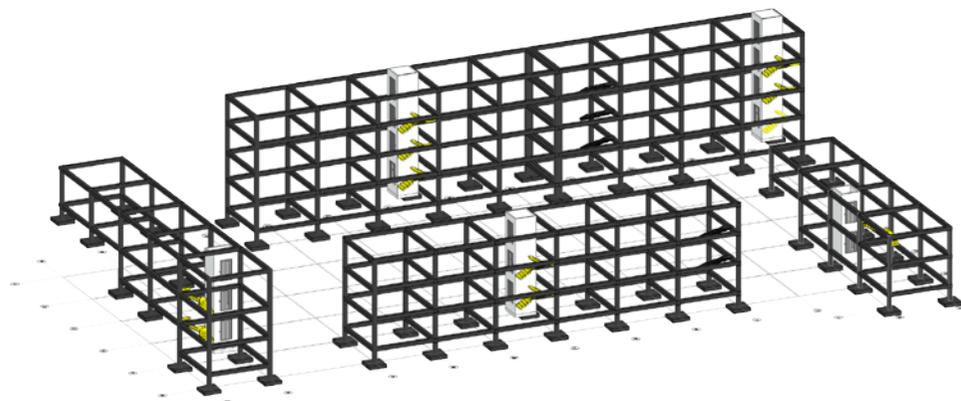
Se ubica y construye las escaleras y ascensores de cada bloque.
